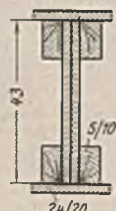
Querschnitt der Gehweglangsträger der 50-m-Fachwerkbrücke.  $l = 6,25$  m.
